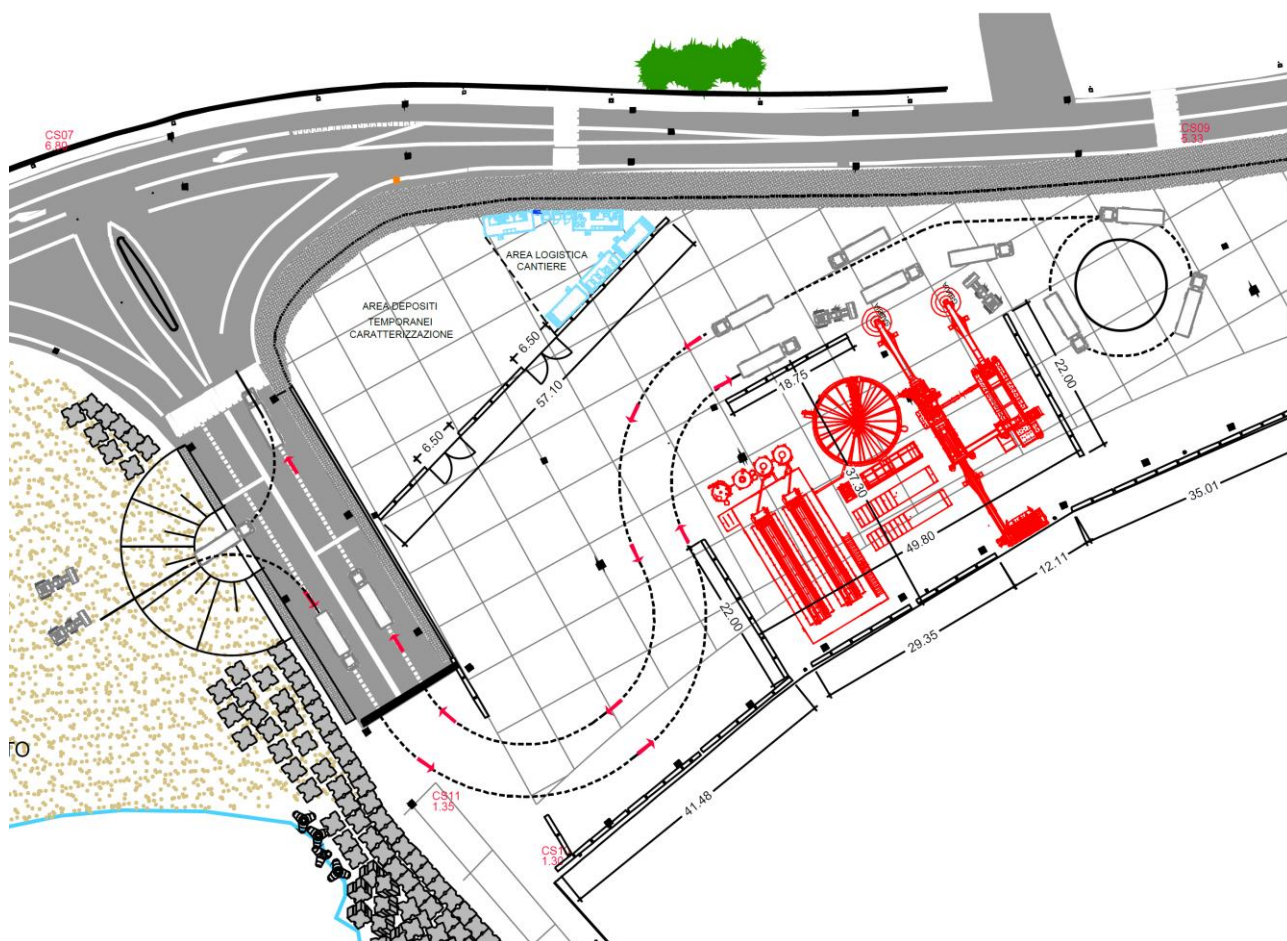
Layout dell’area logistica dell’impianto mobile di soil washing
